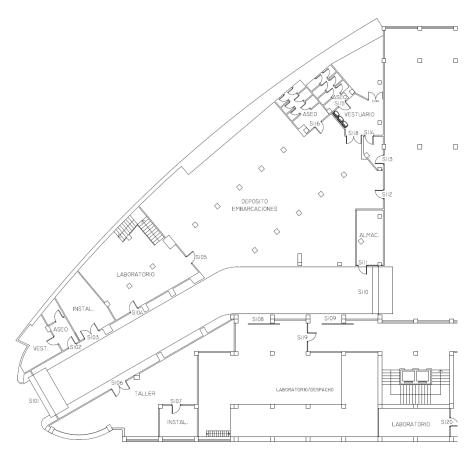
Plano de la Planta Sótano de la Facultad de Náutica de la Universidad de Cantabria.
